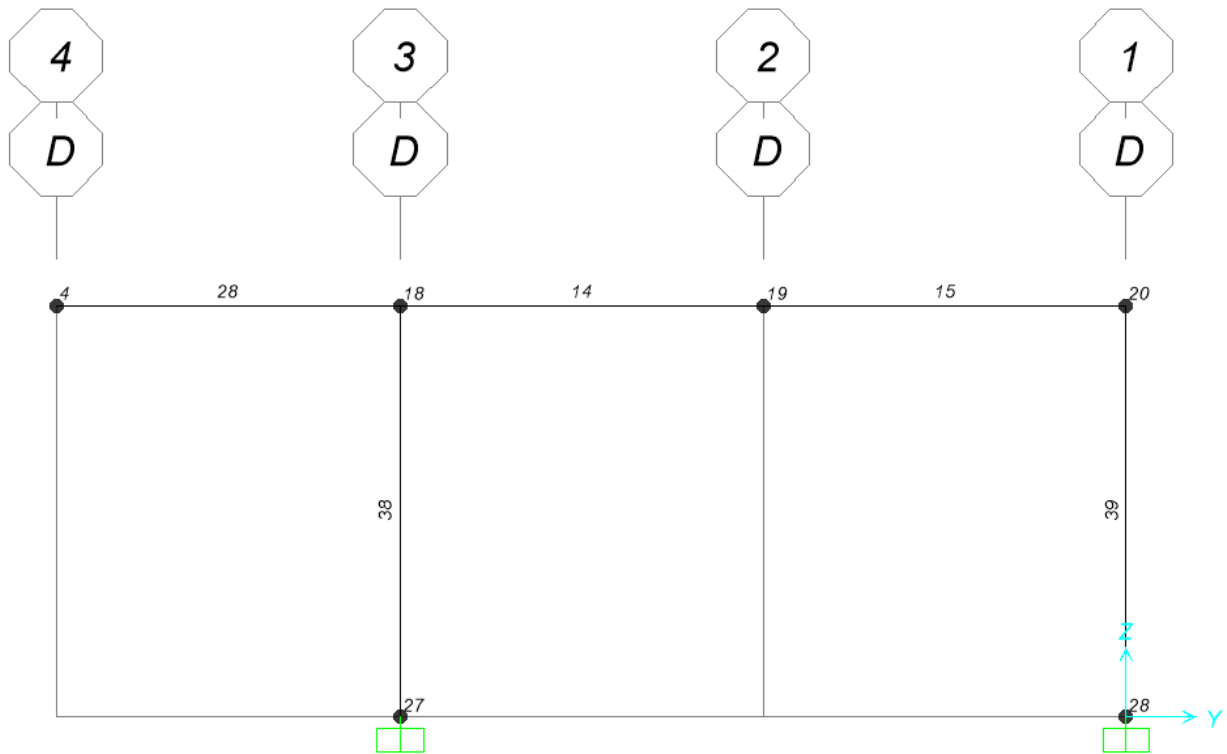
Vista in sezione modello struttura in elevazione –Filo D - numerazione elementi frame e joint
